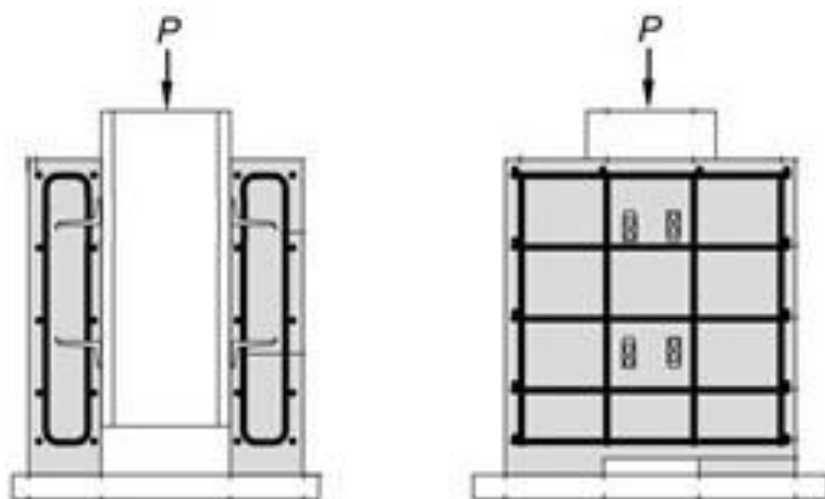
Схема испытания фрагмента сталежелезобетонной балки на сдвиг по ГОСТ Р 58336-2018
